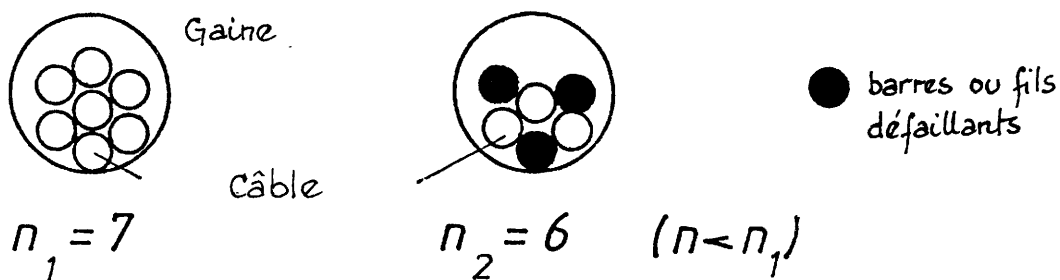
Nombre minimal de barres (ou fils) n_1 et nombre n_2 de barres (ou fils) pouvant être défaillants dans un câble de précontrainte
